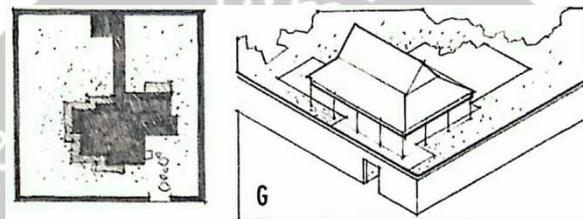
5 Sketsa dan Layout Ruang E
